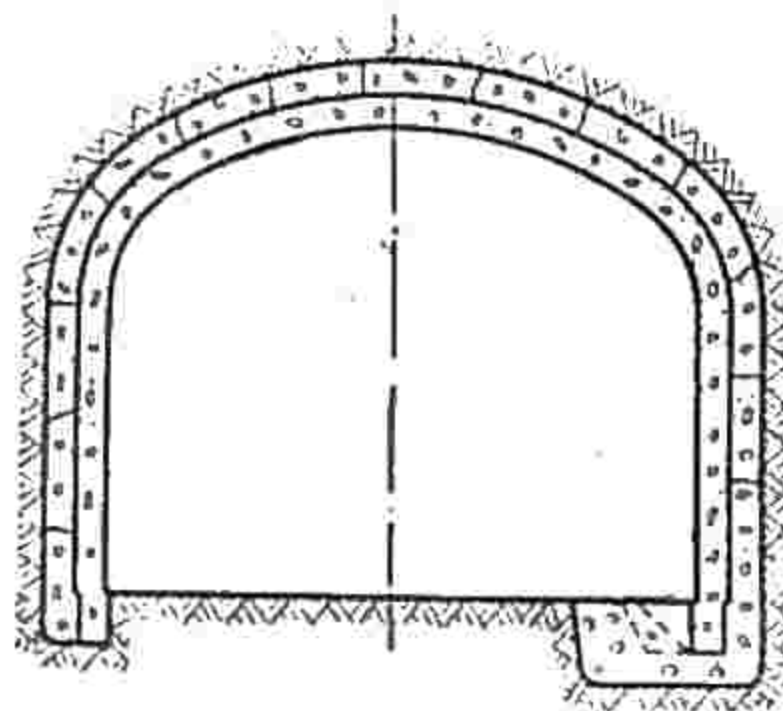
Облицовка бетоном деформированной бетонной крепи
